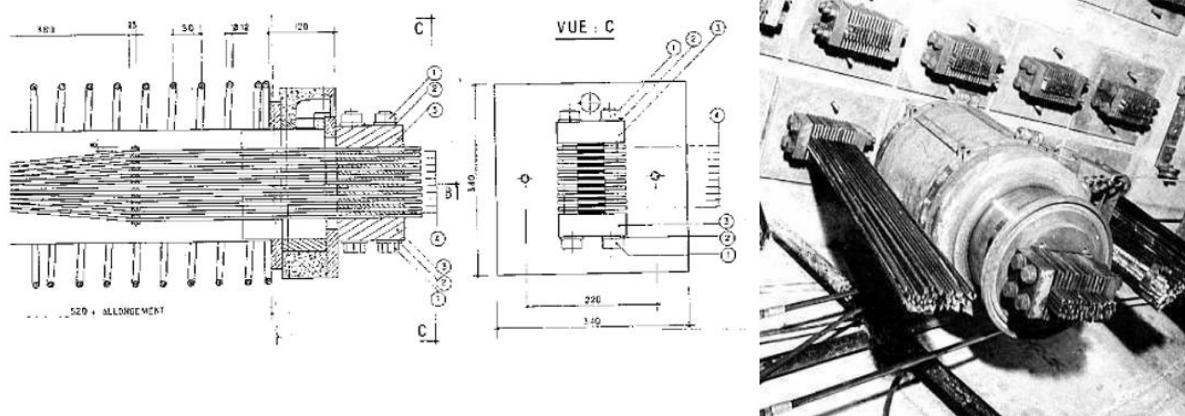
PLAN DE L'ANCRAGE DU SYSTEME KA ET PHOTO DE LA MISE EN TENSION
